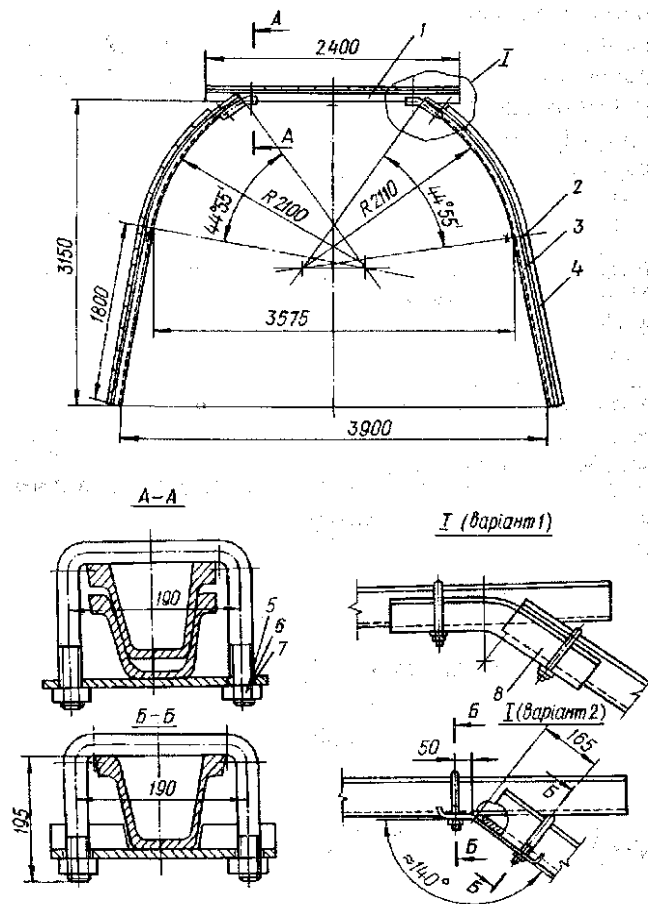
Крепь КМБ: 1 – верхняк; 2 – межрамная стяжка; 3 – стойка; 4 – затяжка; 5 – скоба; 6 – планка скобы; 7 – гайка М24; 8 – башмак; 9 – планка
